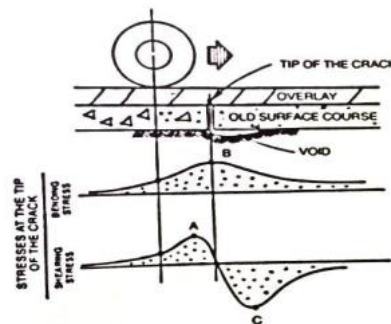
Tensiones desarrolladas para pavimento fisurado.
